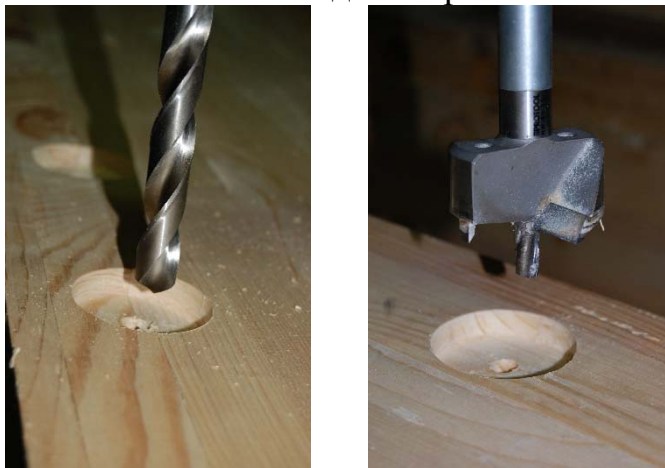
Сверление отверстий под шайбы и стяжные болты
